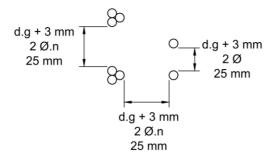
Jänteiden suojaputkien sijoittelu.
